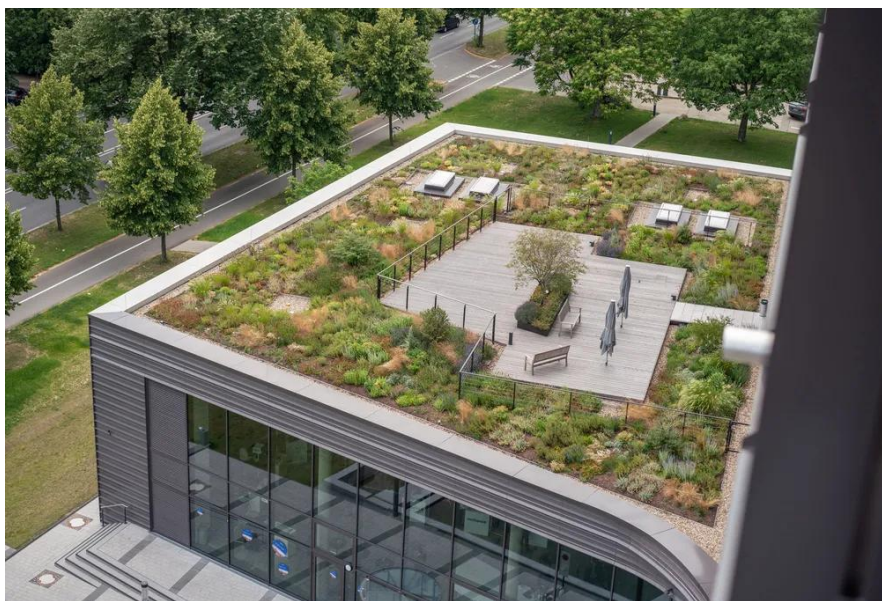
Telhado verde construído sobre prédio da Escola de Finanças e Administração de Frankfurt (Alemanha) (Fonte: Frank Rumpenhorst/dpa/Picture-Alliance/AFP/Arquivo).
